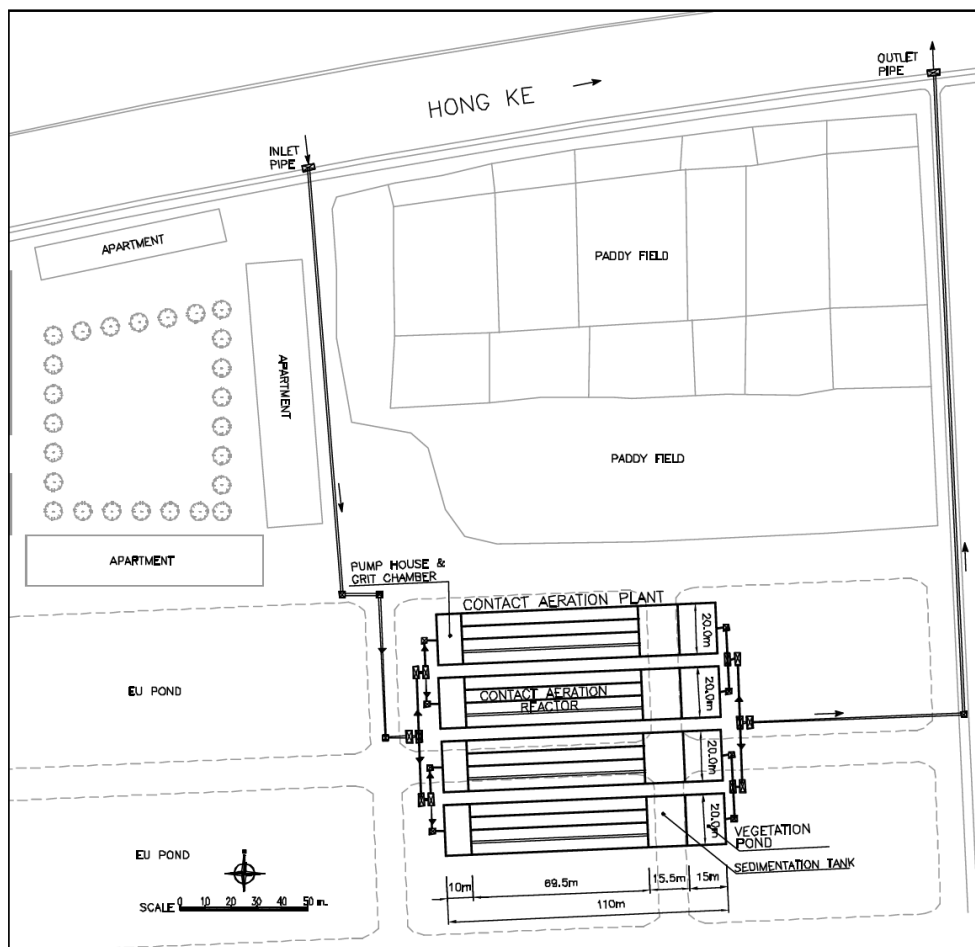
Hong Ke 流末における接触酸化型処理施設の平面図
